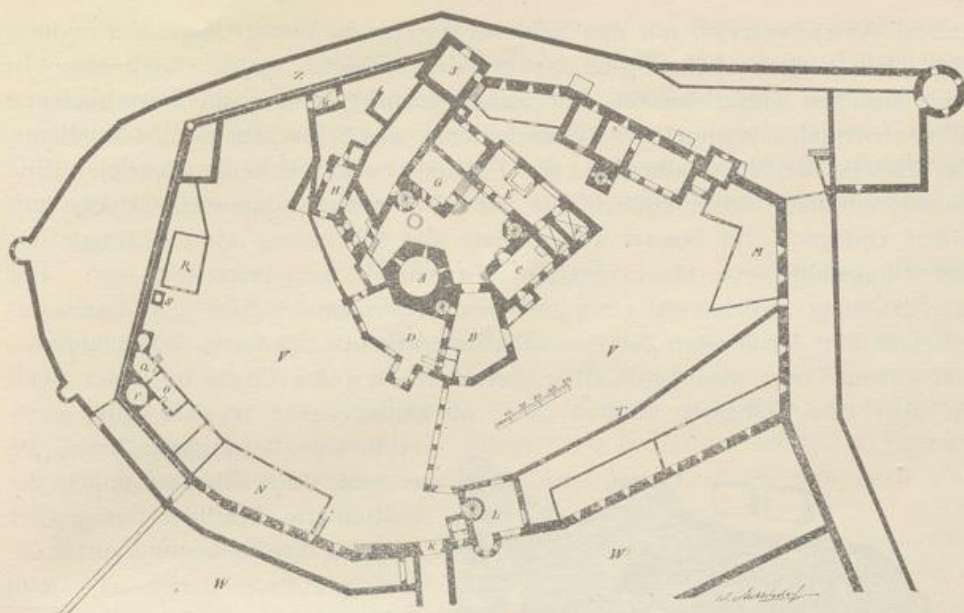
Grundriss des Schlosses um 1600.
